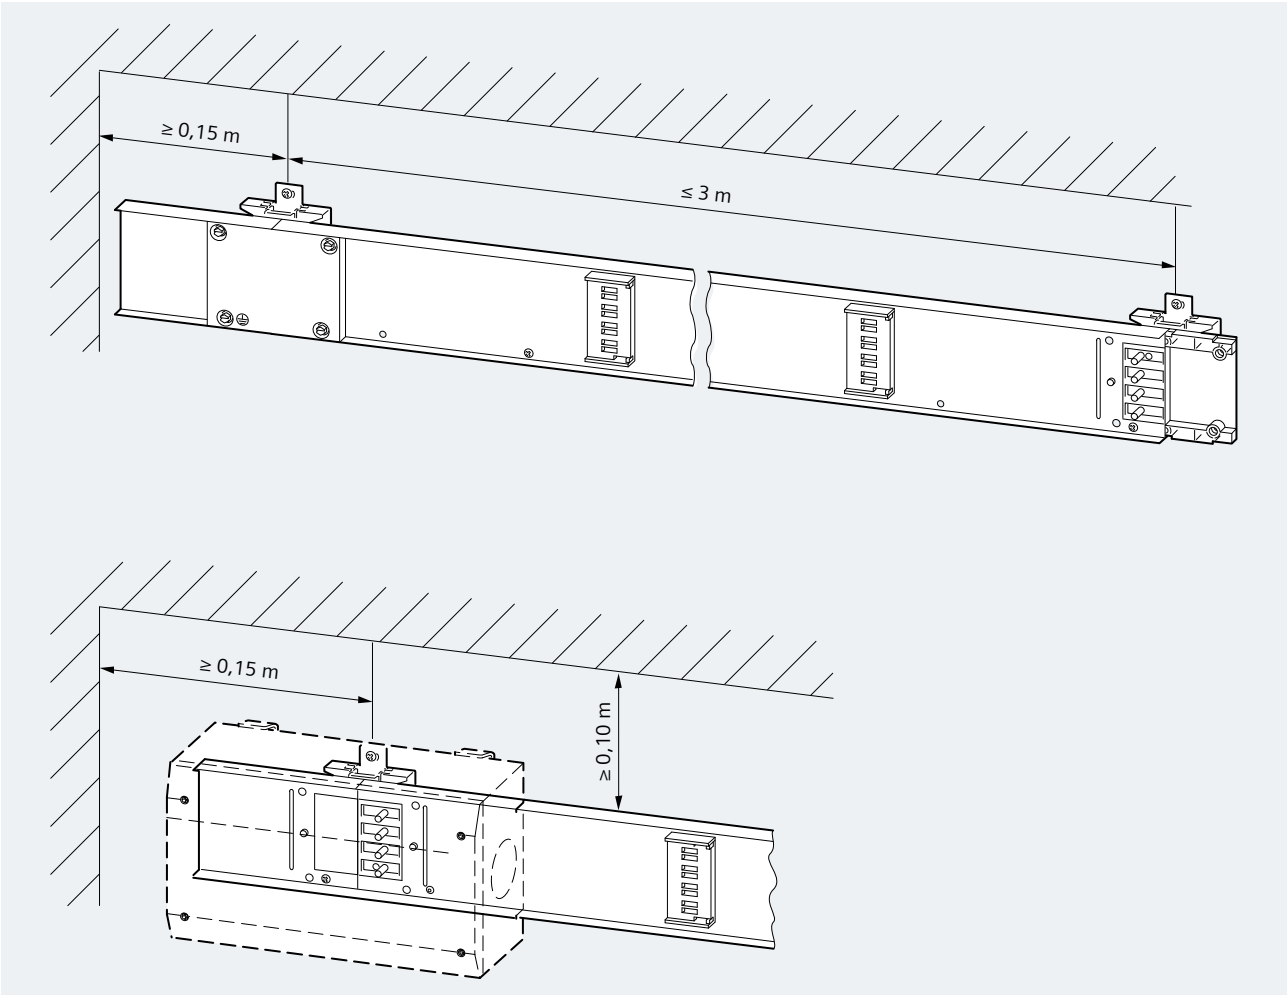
/17: Wand- oder Deckenbefestigung mit BD01-B
